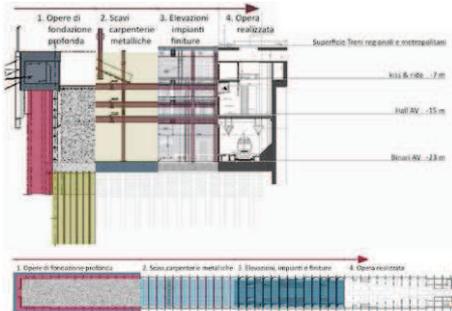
Organizzazione strutturale e sequenza delle fasi costruttive
